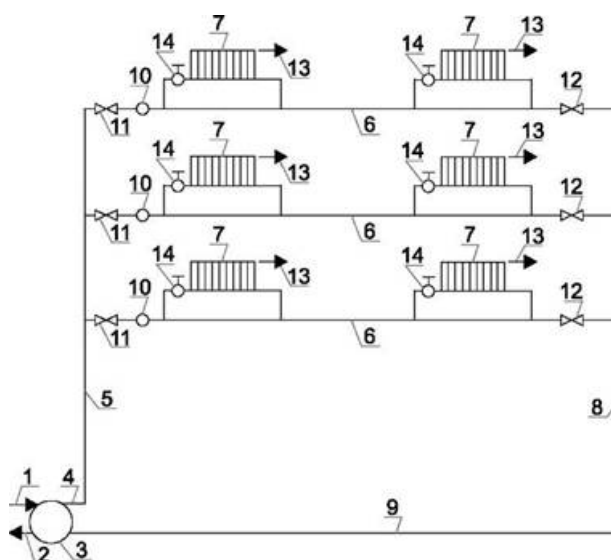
Схема системы отопления зданий, имеющих небольшое количество этажей: 1 - подающий теплопровод сетевой воды; 2 - обратный теплопровод сетевой воды; 3 - индивидуальный тепловой пункт; 4 - подающий теплопровод системы отопления; 5 - вертикальный подающий стояк; 6 - поэтажная горизонтальная ветка; 7 - отопительные приборы; 8 - обратный стояк; 9 - обратный теплопровод системы отопления; 10 - квартирный тепловой пункт; 11, 12 - вентили; 13 - воздушные краны; 14 - краны, для регулирования расхода воды
